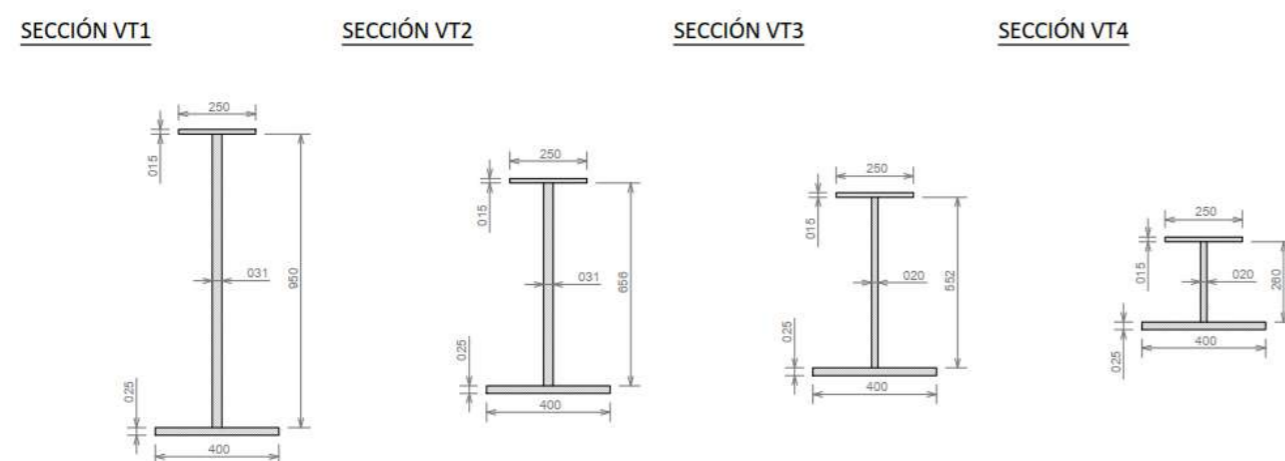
Secciones transversales características de las vigas transversales (fuente: elaboración propia)
